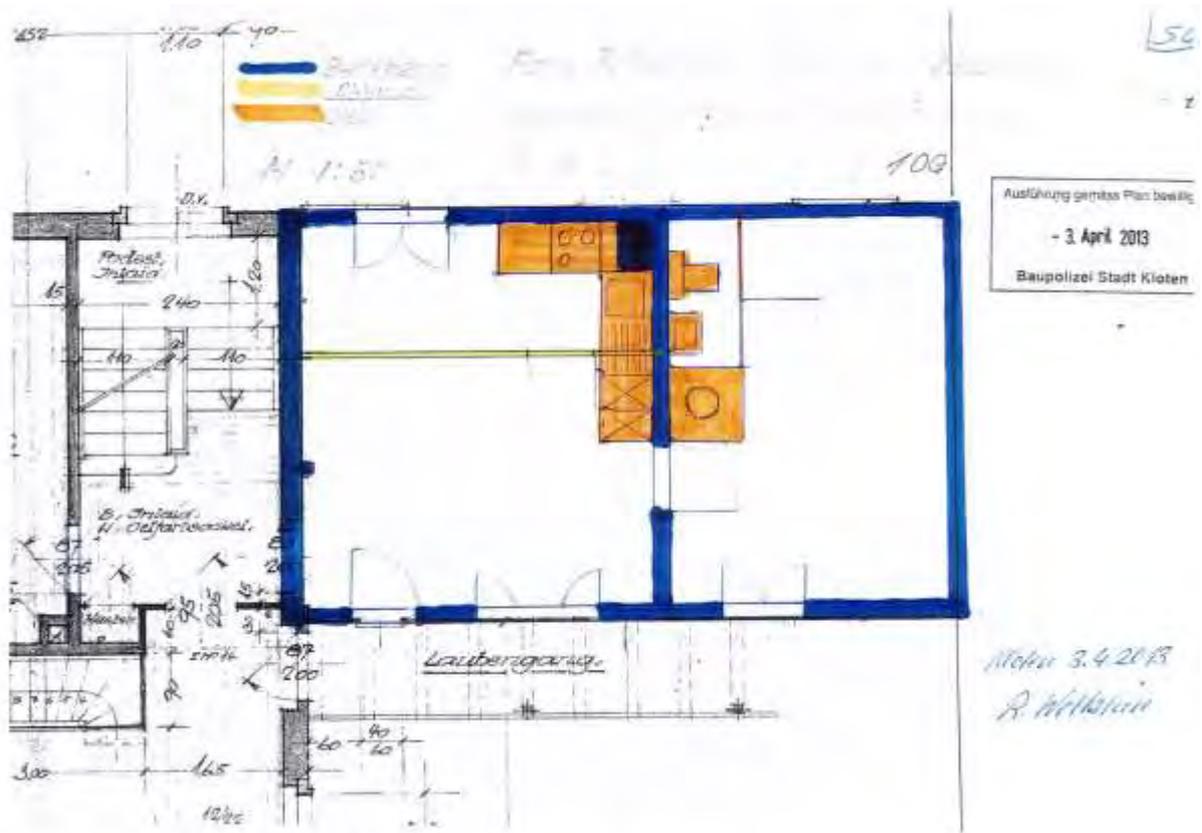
Umbau Verbindungsbau im 1. Obergeschoss, 2013. Bauamt Stadt Kloten.
